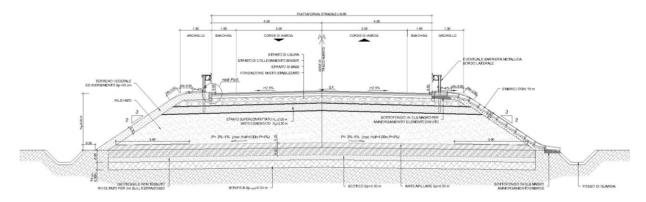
Cat. F1 sezione tipo in rilevato Hril ≤ 6.00 m
